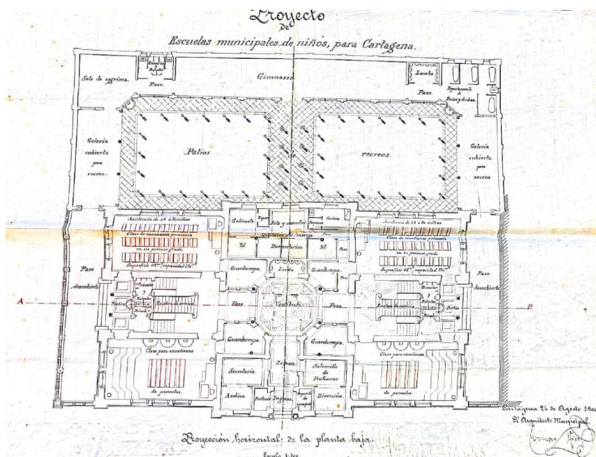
Planta baja - Proyecto Original 1900. (Archivo Municipal de Cartagena)
